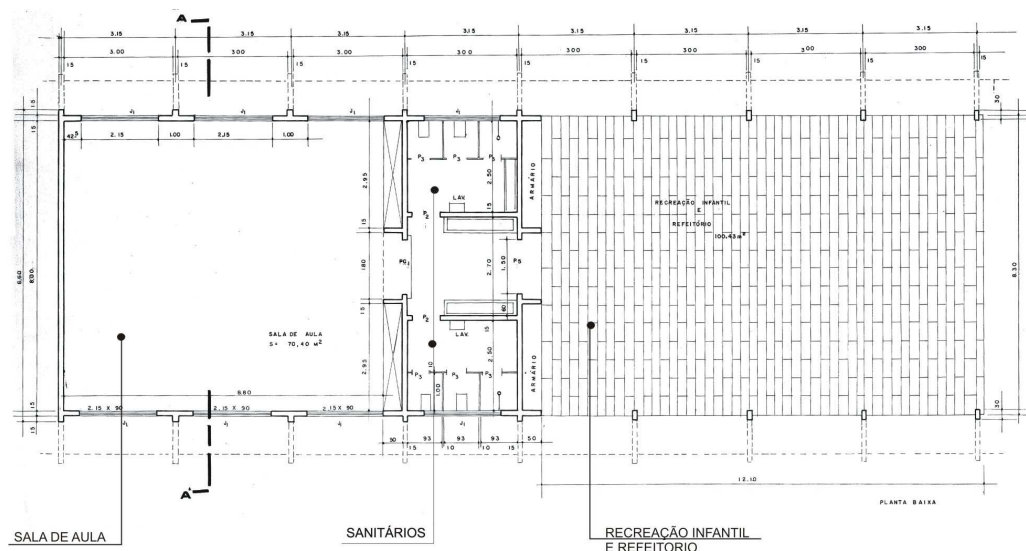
Planta do pavilhão de recreação infantil e refeitório. (Fonte: Montado a partir do Findes)
